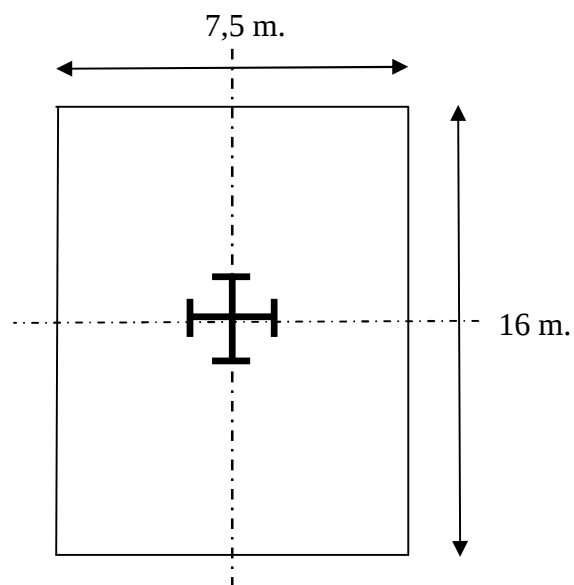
La surface afférente sur le poteau le plus sollicité.
